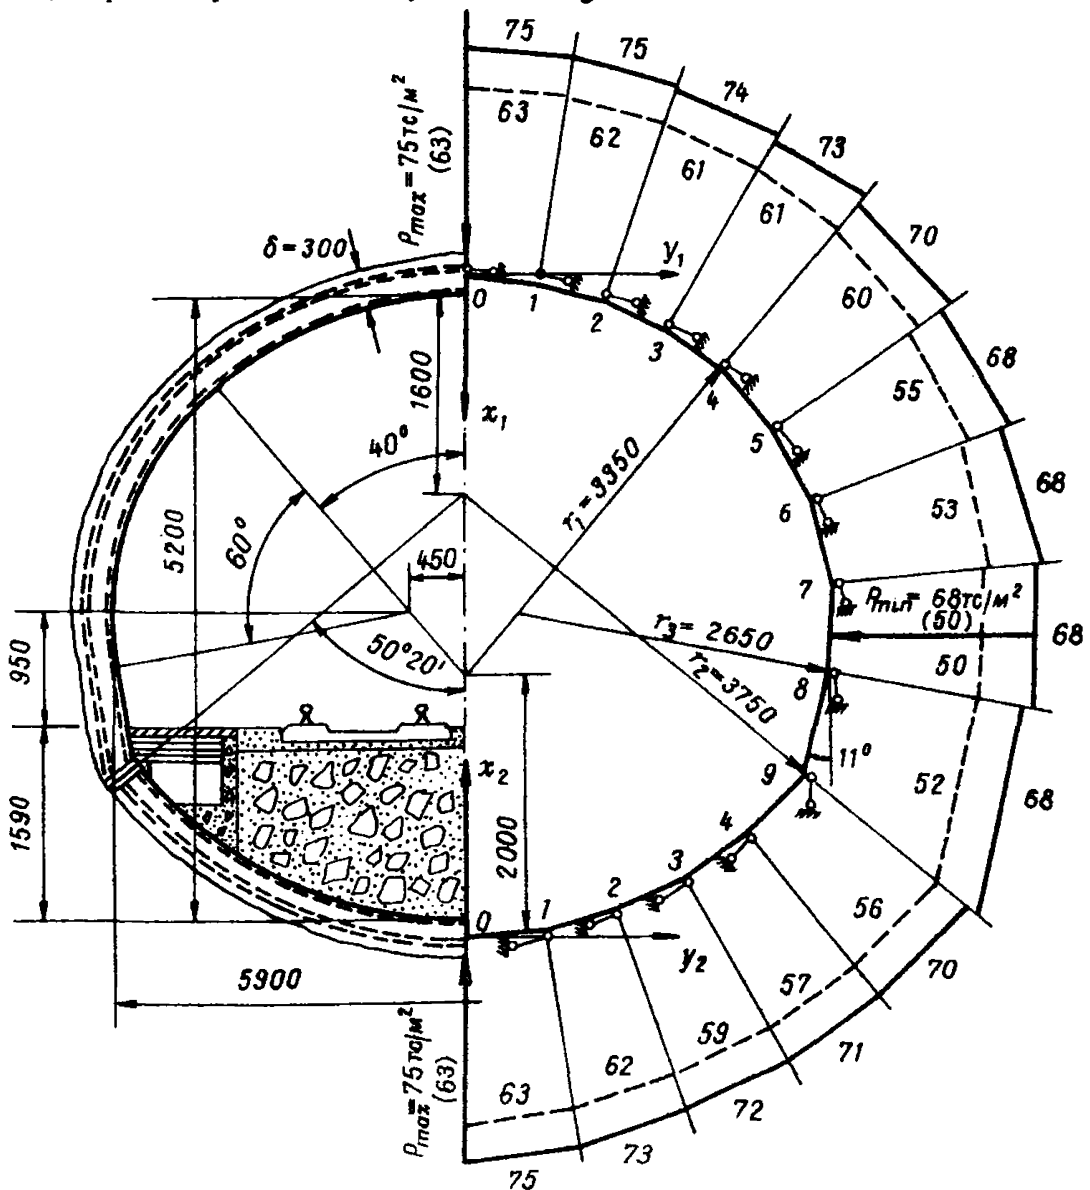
Очертание и расчетная схема замкнутой железобетонной крепи с жесткой арматурой и выположенным сводом:
